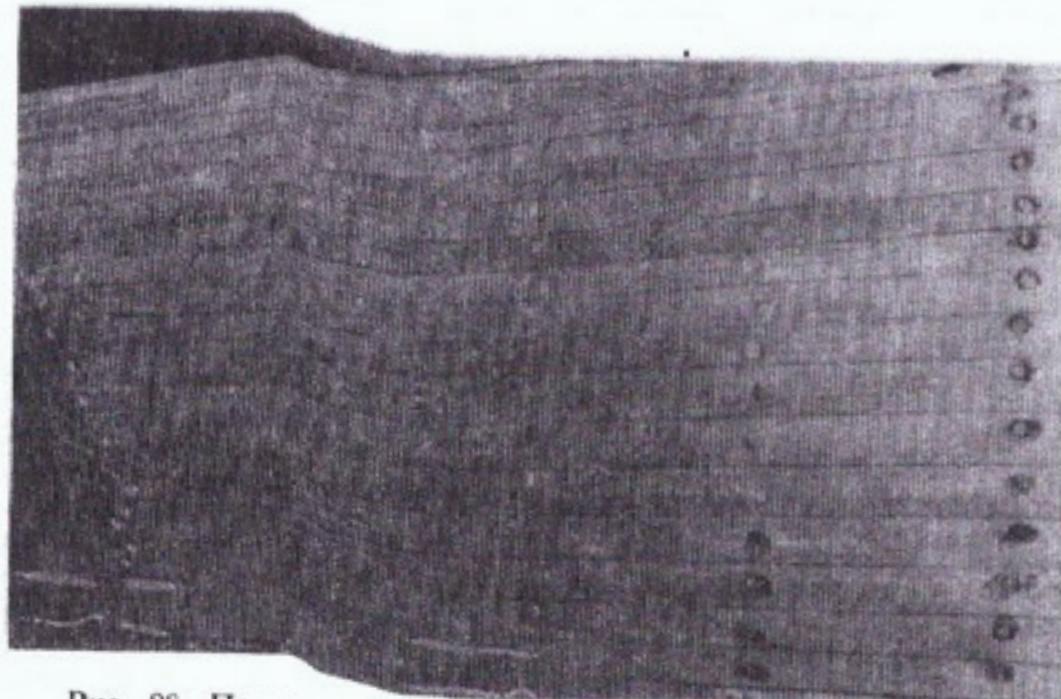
Постановка пробок в наружной обшивке корпуса.
